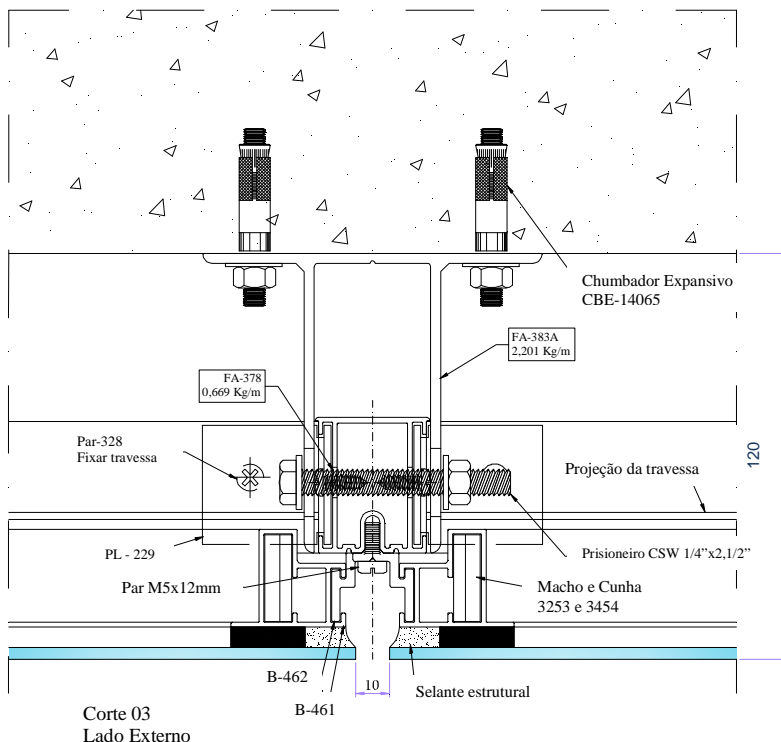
Corte 03: Corte horizontal com detalhes do sistema construtivo. Cotas em mm.
